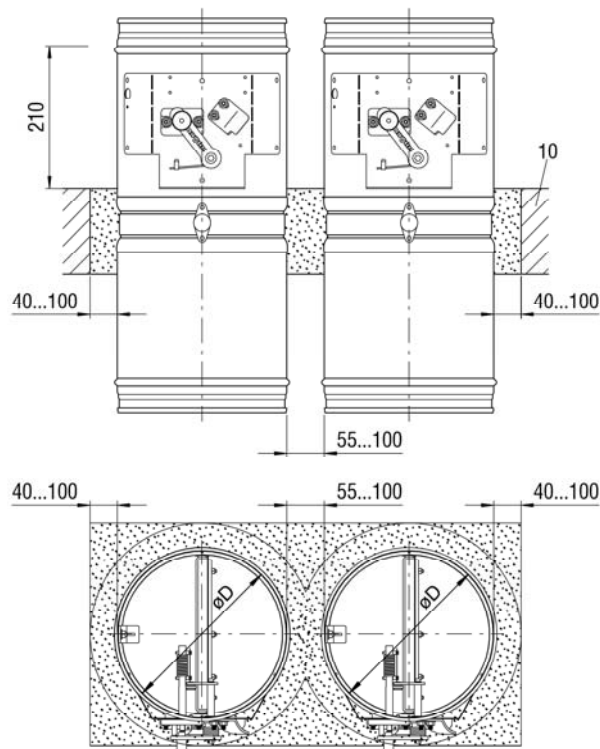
ringopeningsafmetingen volledige uitmorteling, massieve plafonds (uitsparing rond of hoekig)
